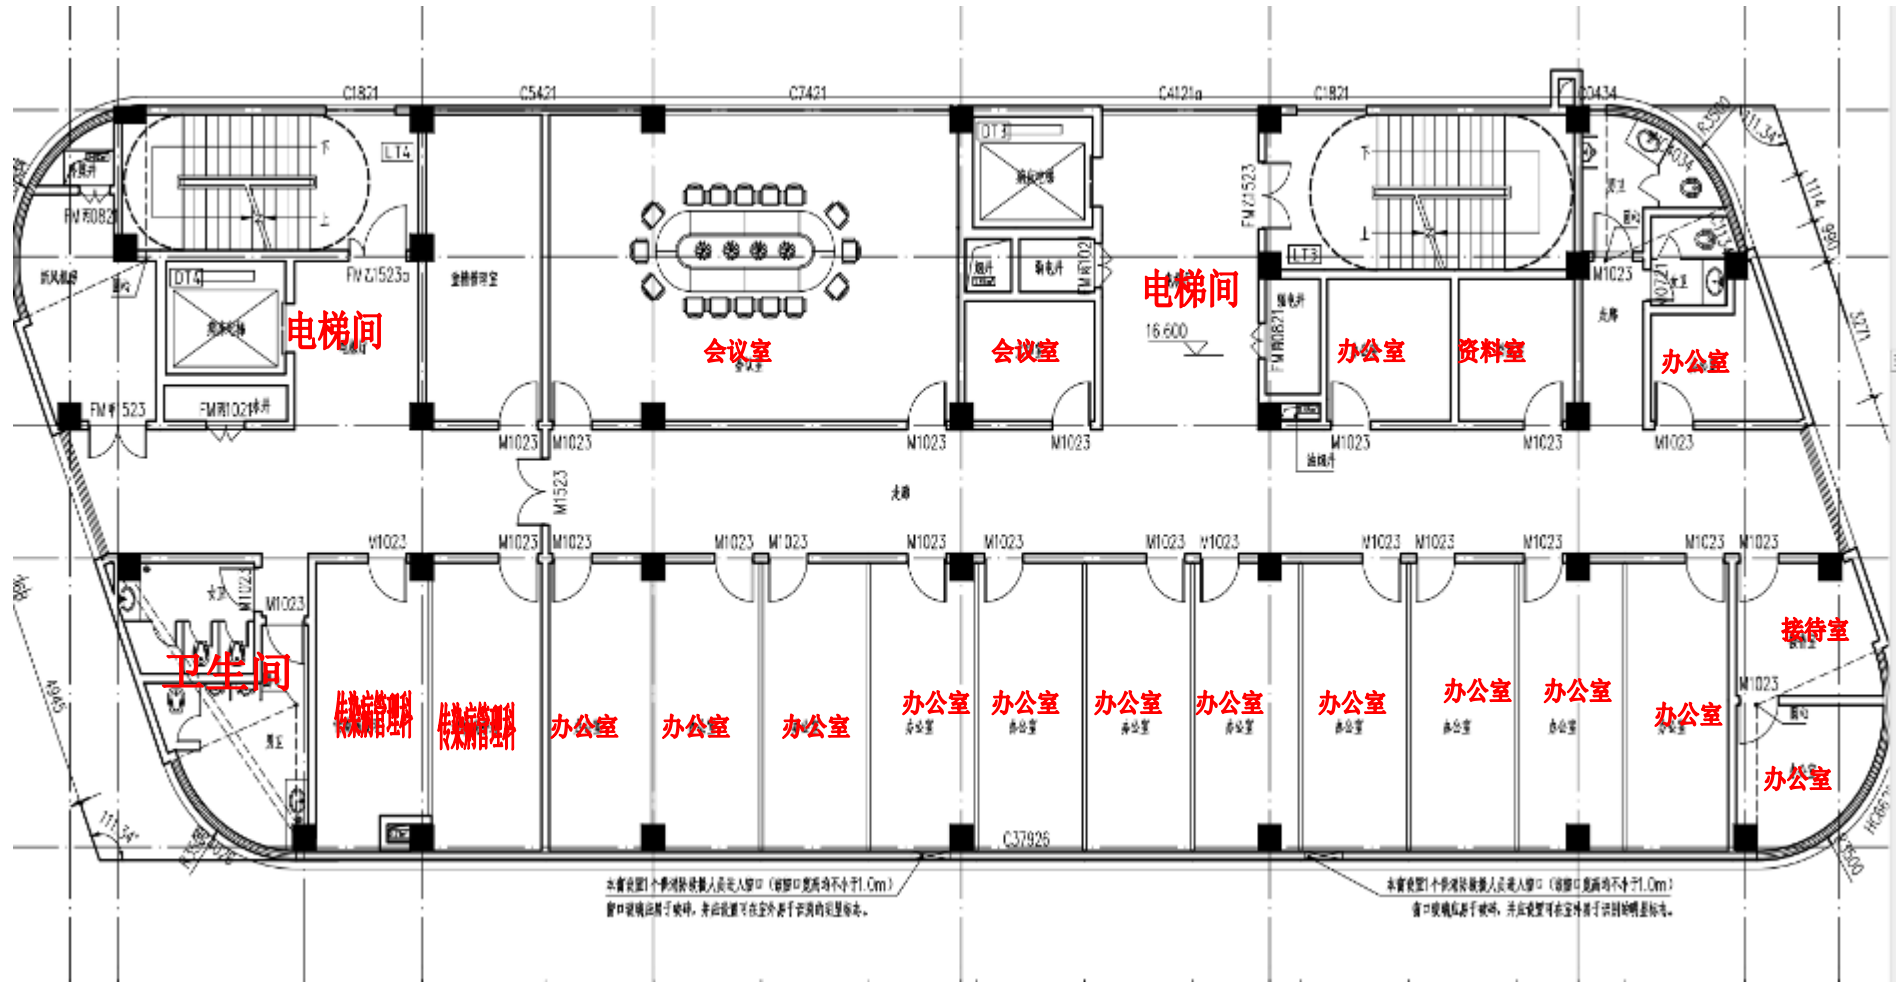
项目第二社区卫生服务中心大楼五层平面图
